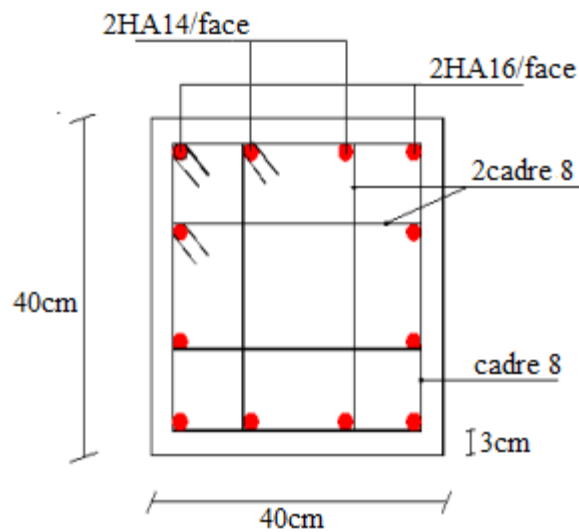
Schéma de ferraillage poteaux 10^{ème} étage
